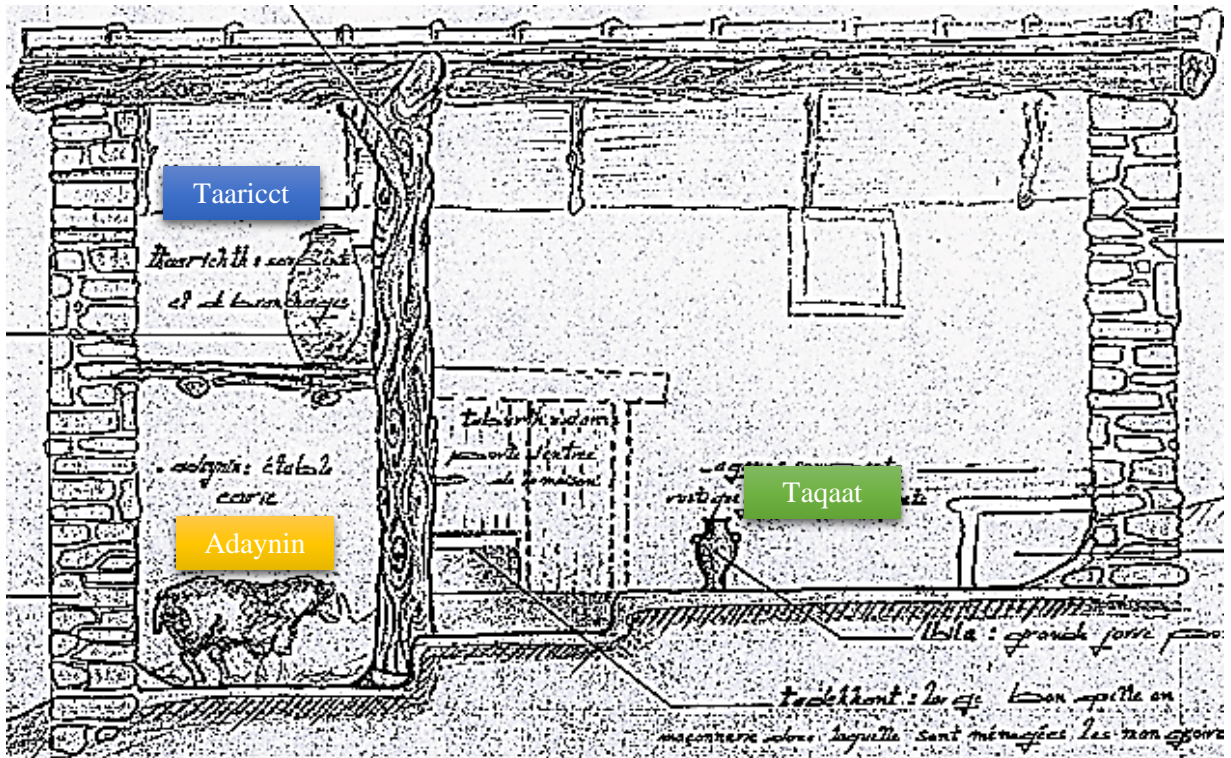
Coupe longitudinale d'une maison traditionnelle
